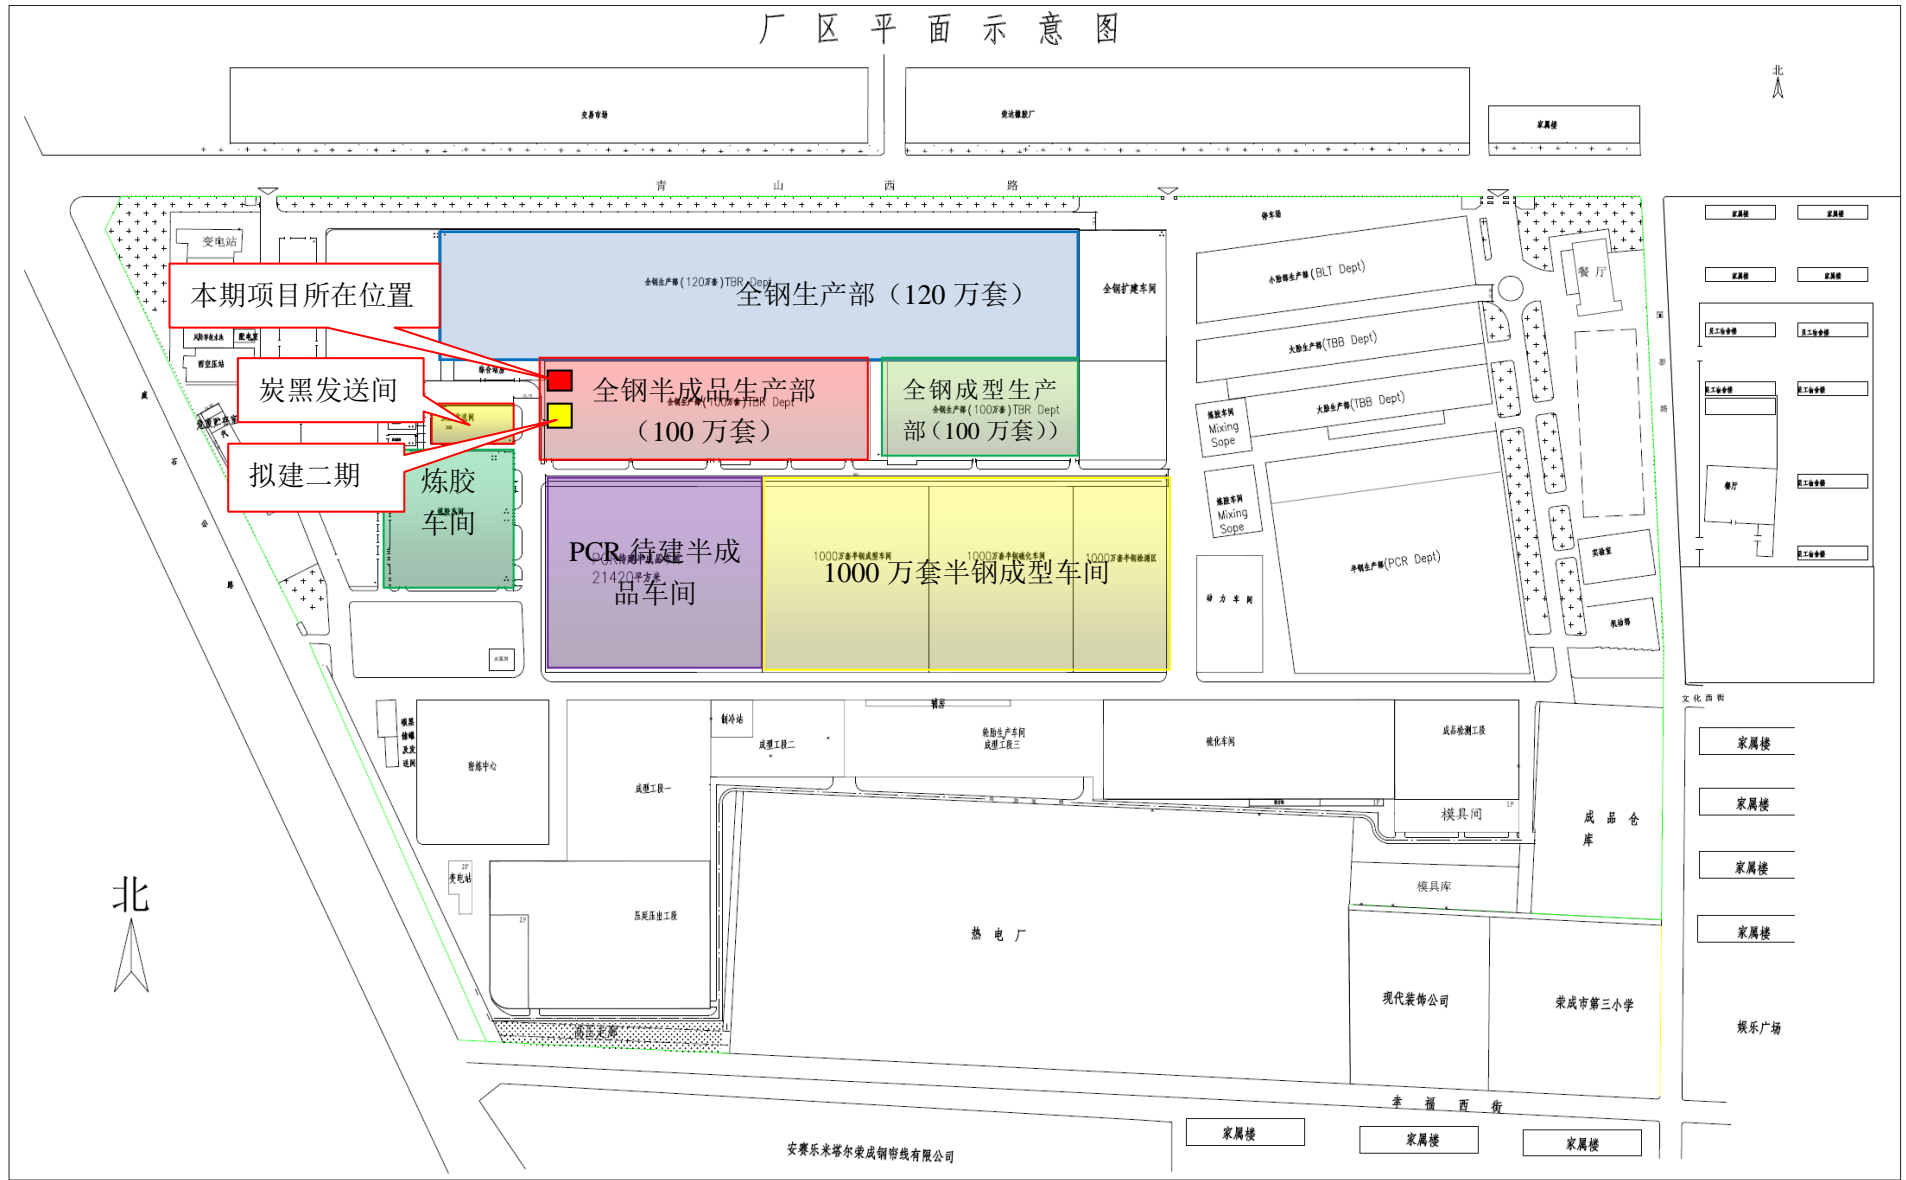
浦林成山（山东）轮胎有限公司厂区总平面图
